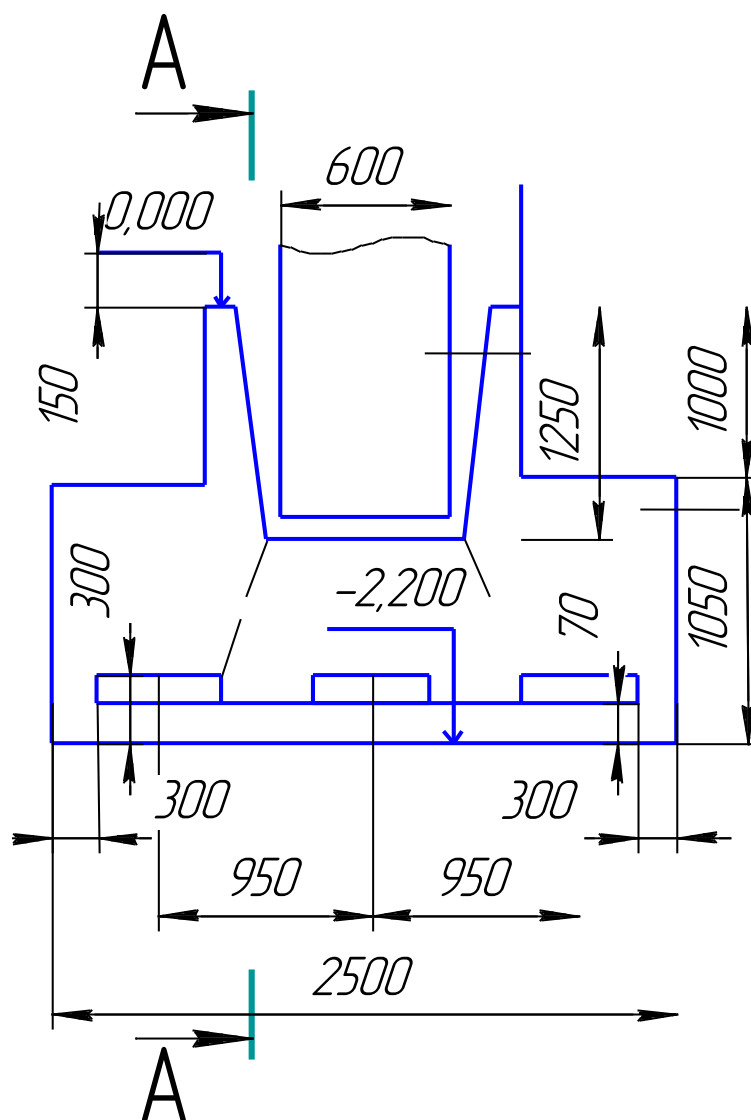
Свайный фундамент на среднюю железобетонную колонну и расчетная схема
